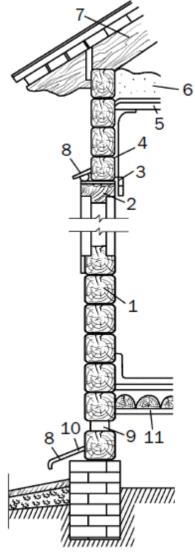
Конструкция брусчатой стены: 1 – брусья; 2 – оконный блок; 3 – конопатка; 4 – слой штукатурки; 5 – щитовой накат по балкам; 6 – засыпка; 7 – стропило; 8 – слив; 9 – продух; 10 – слой гидроизоляции; 11 – пол
